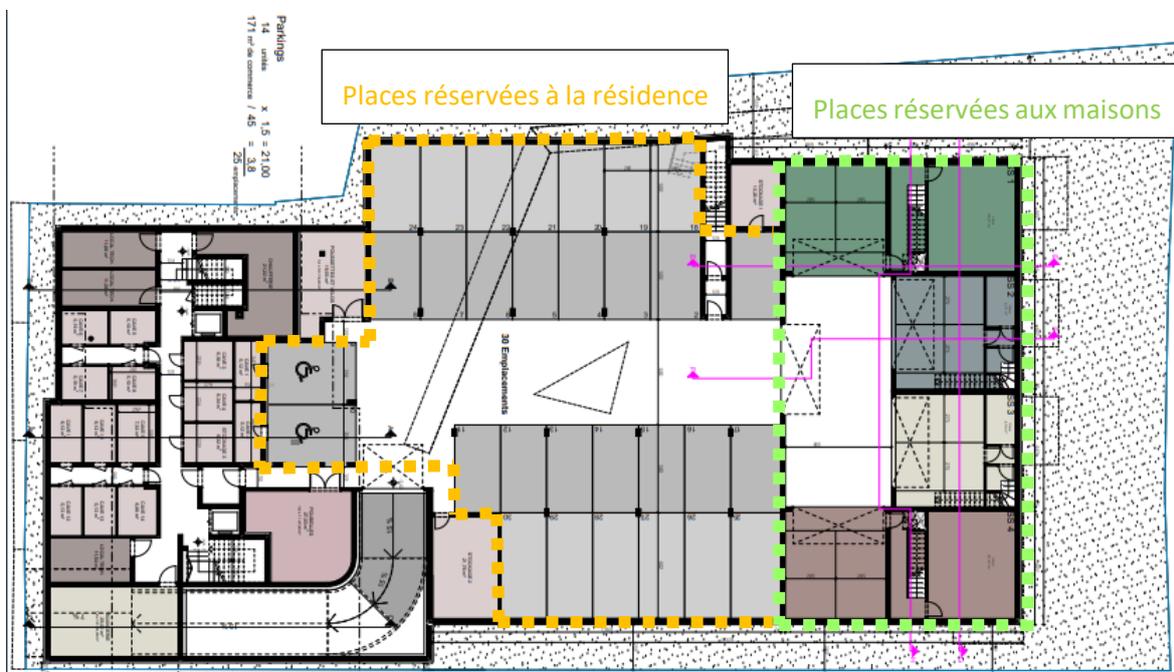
proposition de plan pour le parking souterrain (Source : ZAK architectes)
